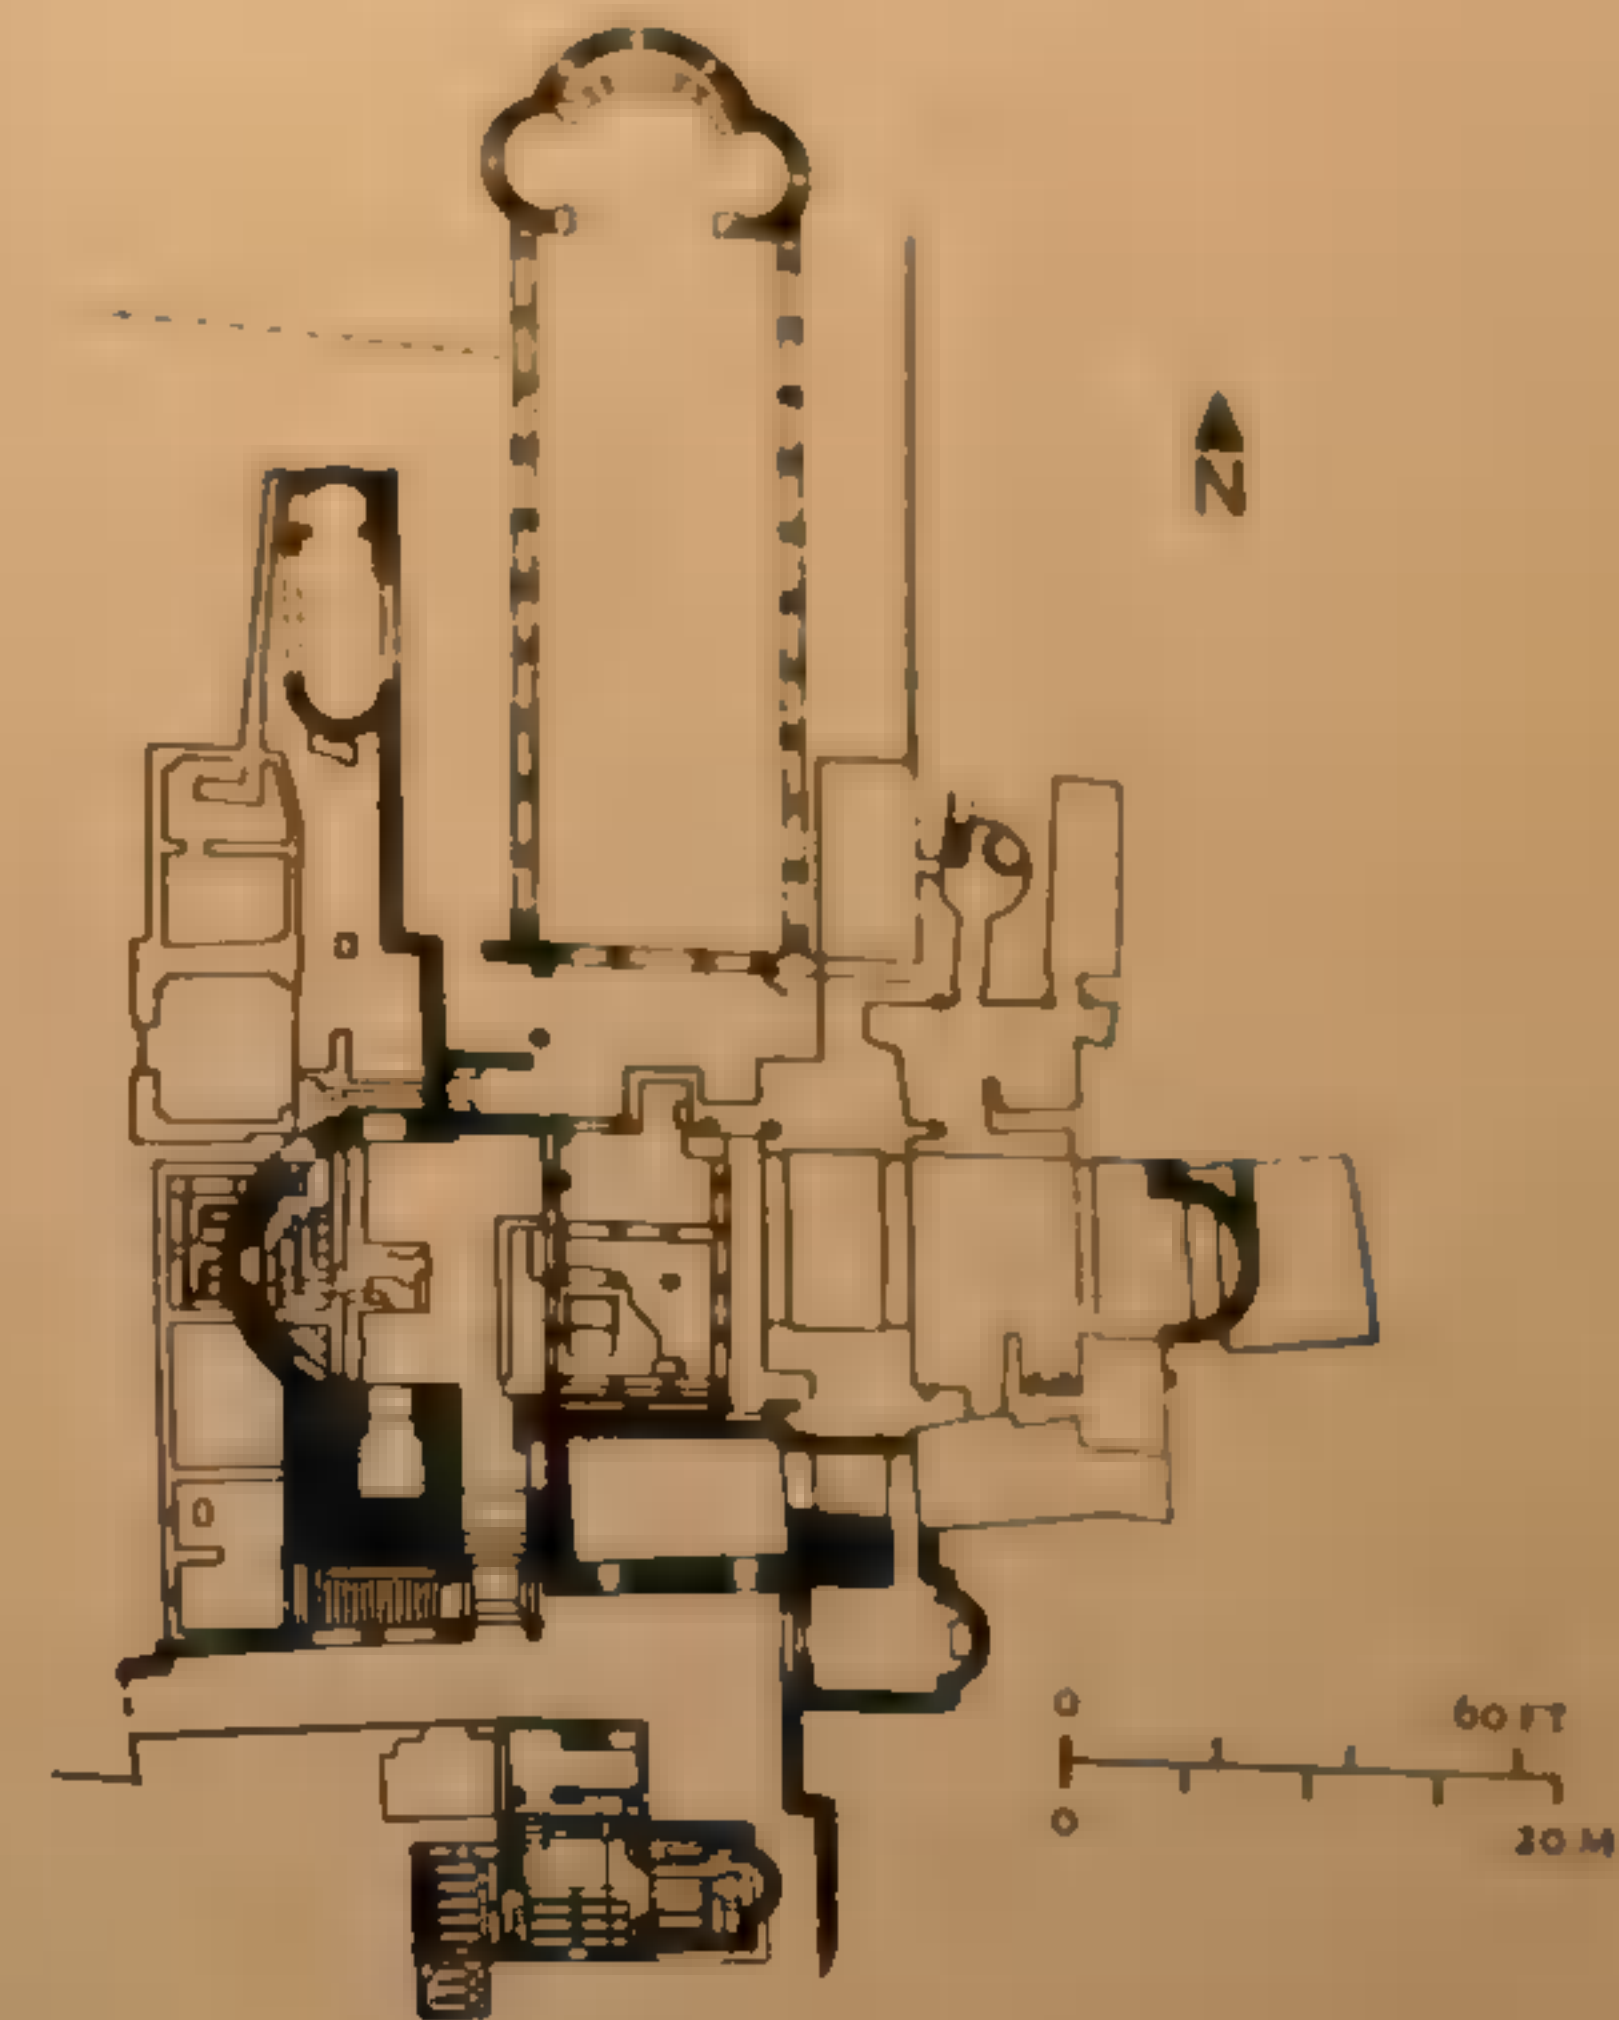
Cimitile, Ausschnitt aus einem Plan des Pilgerheiligtums von 1965 (KRAUTHEIMER)
